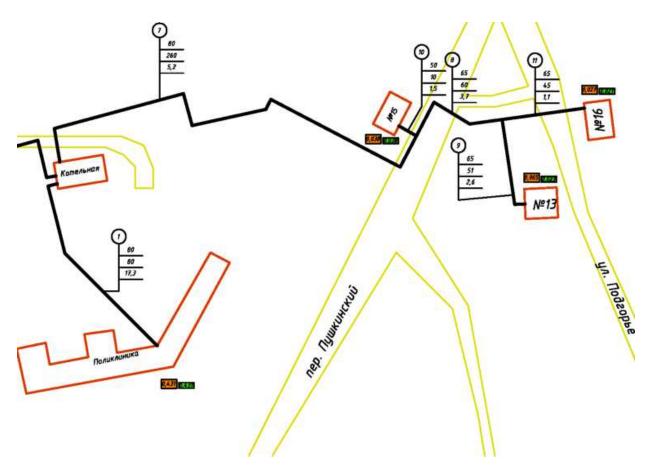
Схема сравнения расчётных и фактических тепловых нагрузок по котельной 2 Больничная
